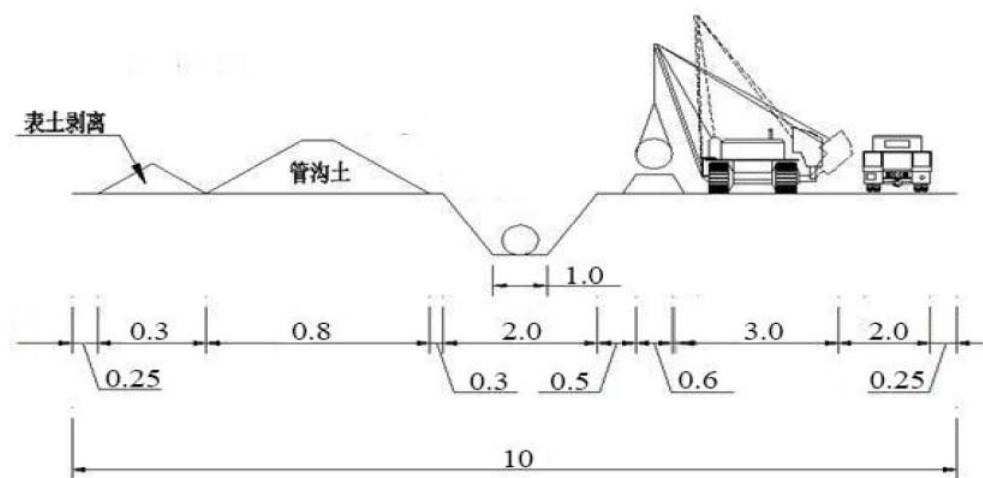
管道敷设施工作业带布置示意图（单位：m）
